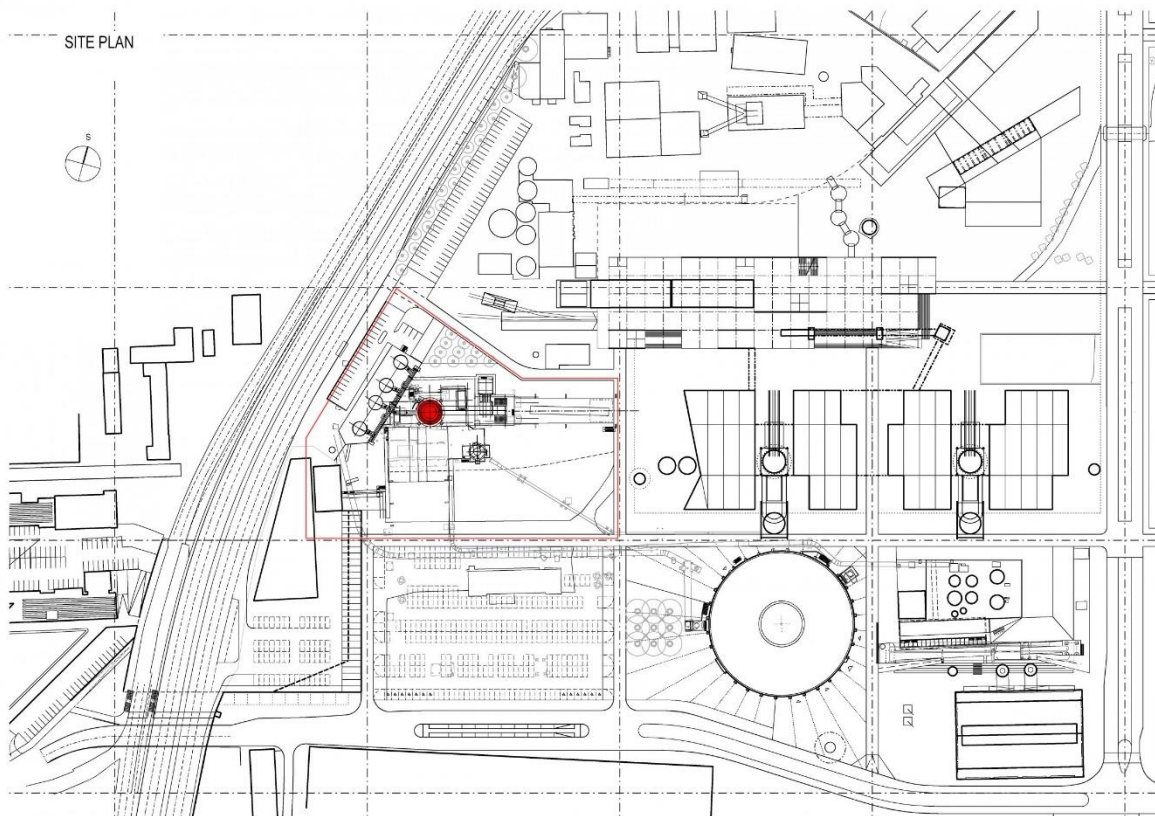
Plan du site (©P.A.C.E., s.d.).
